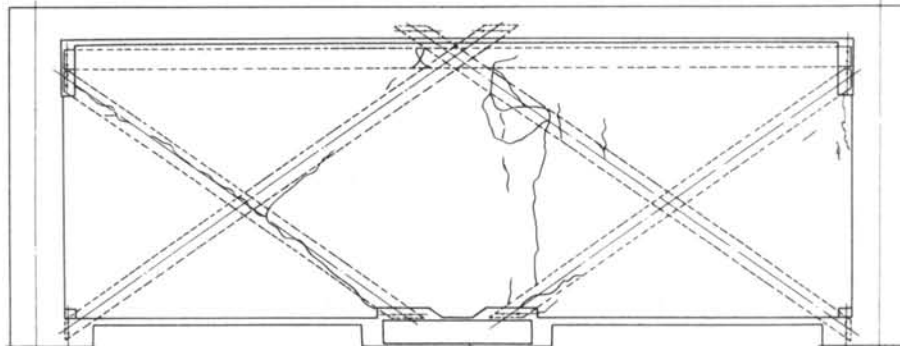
試験体-2 試験前ひびわれ状況図(版裏側)
